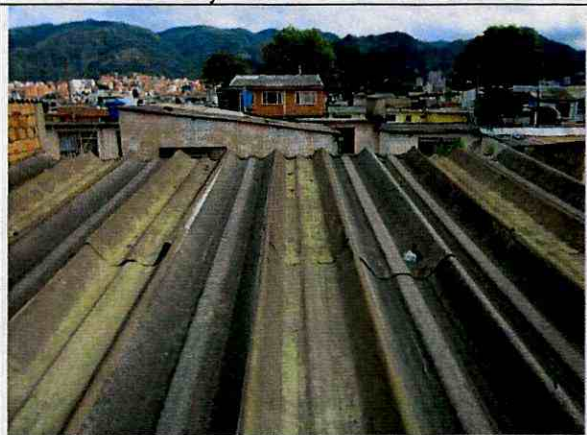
Cubierta sector posterior, sin evidencia de daños.
